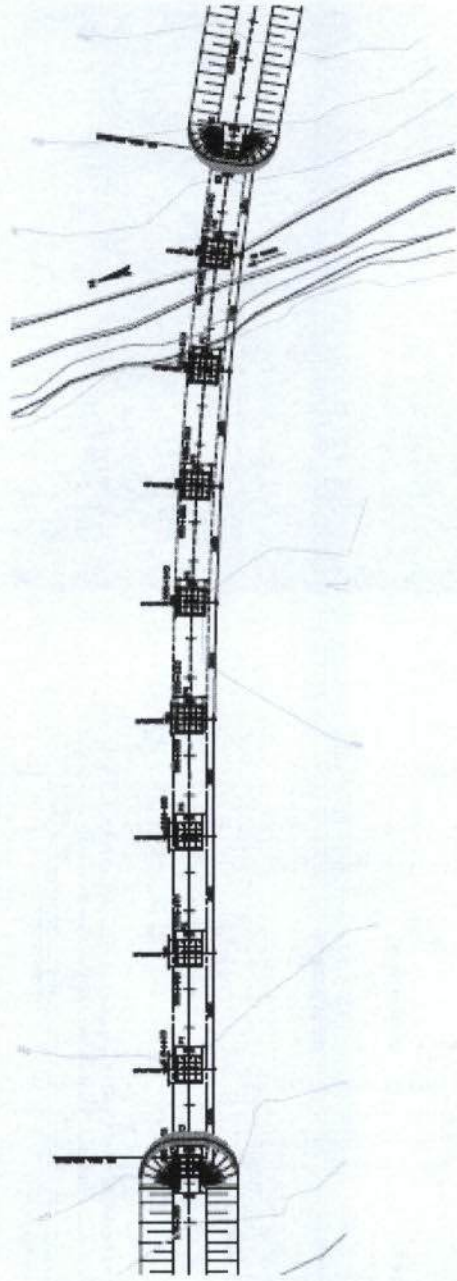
Projeto da ponte sobre o Rio Grande (planta de situação)
